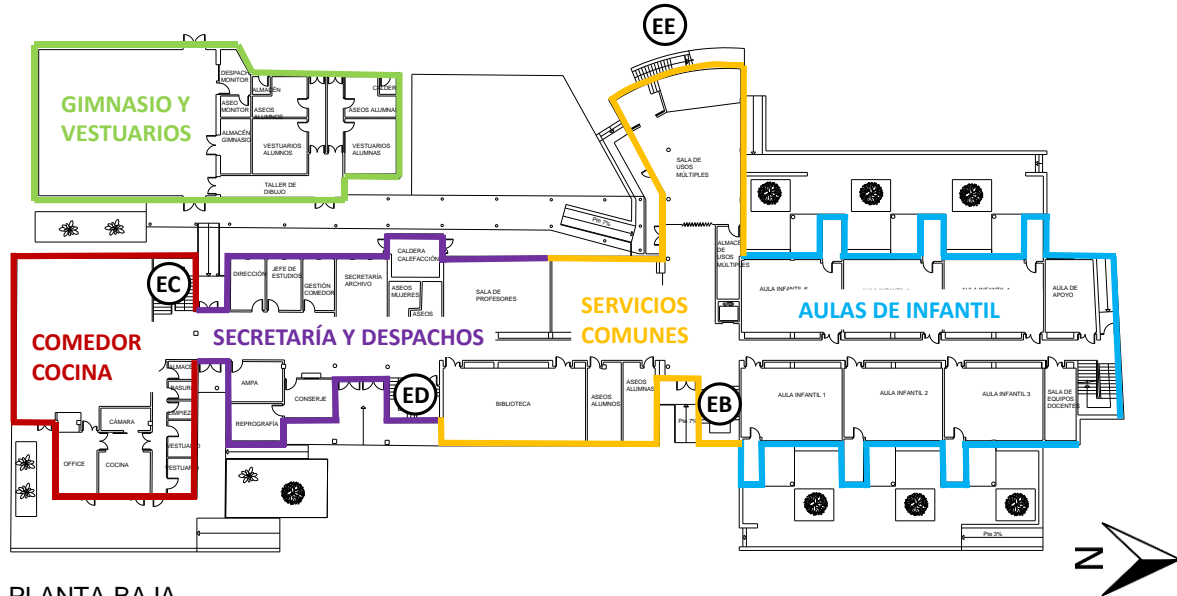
DISTRIBUCIÓN PLANTA BAJA
